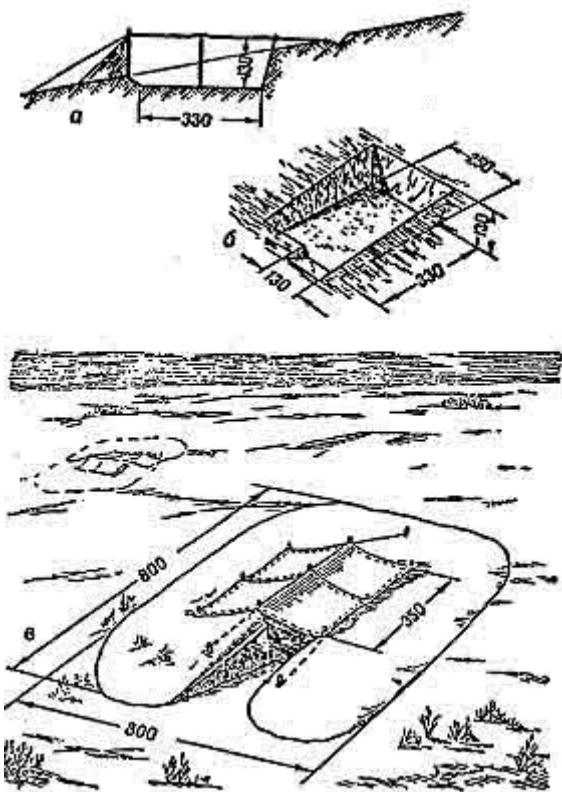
Укрытие плащ-палаток над котлованом, для шести человек.
